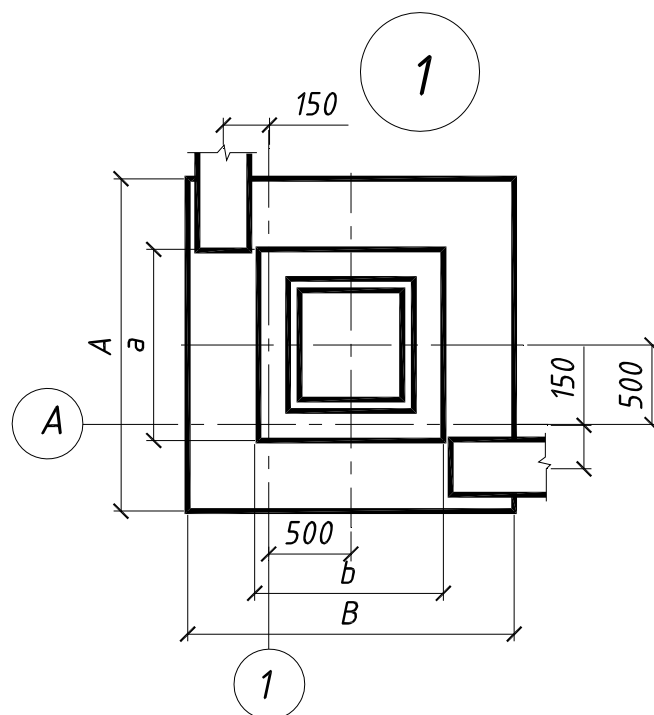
Узел опирания фундаментных балок на угловой фундамент
